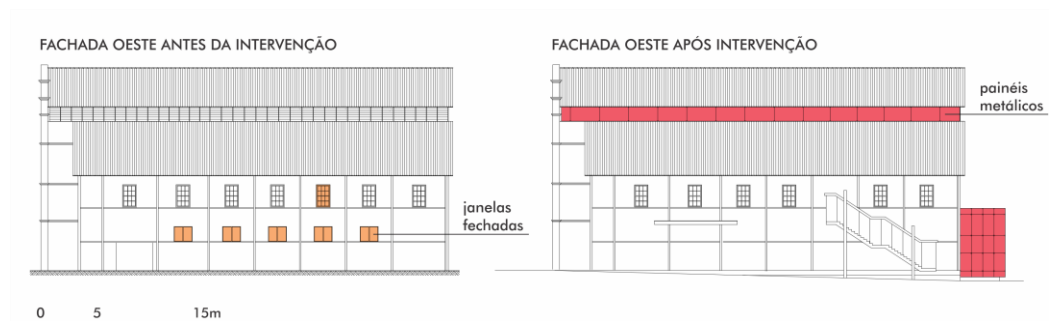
Fachada oeste Teatro Engenho antes e depois da intervenção.
